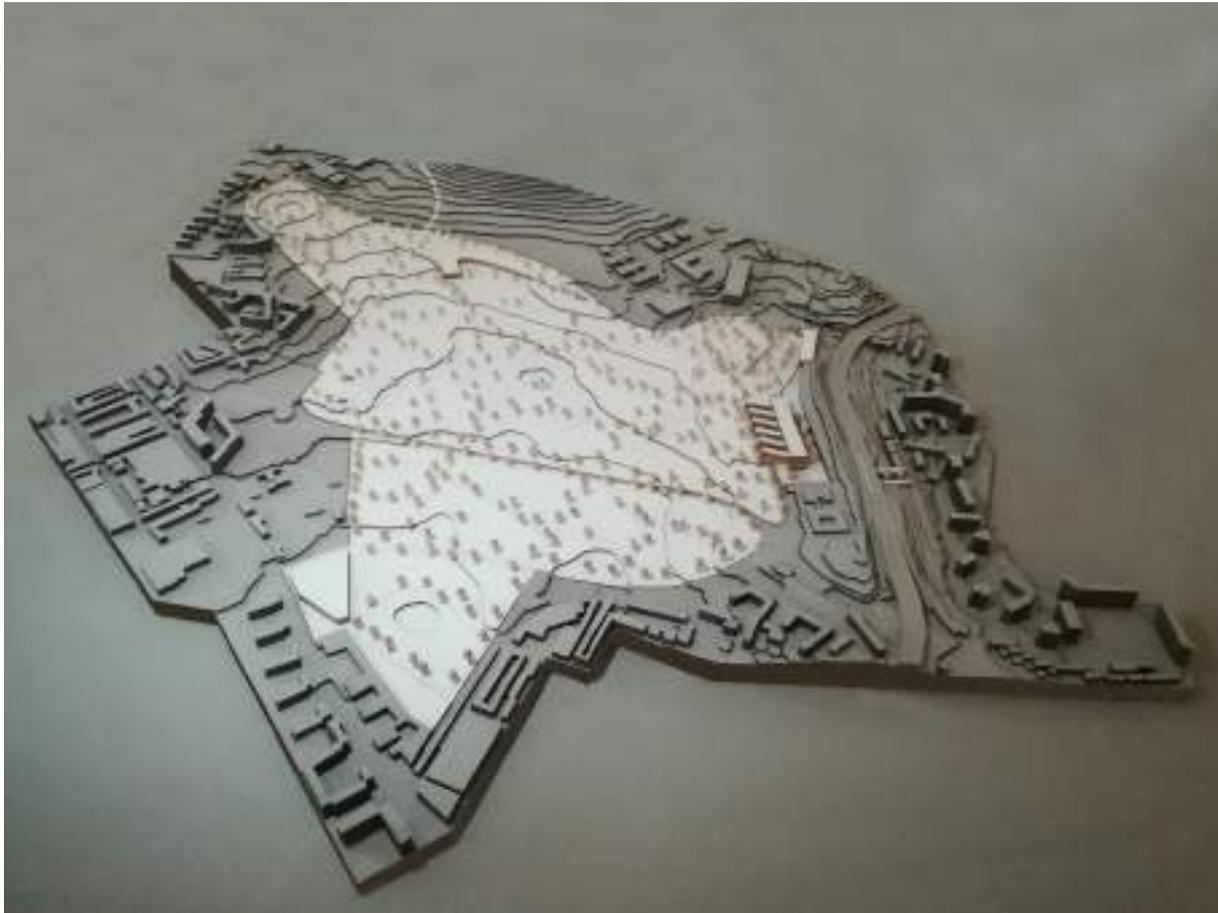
Vista geral da maquete com equipamentos (Fonte: Marco Andrade, 2019)
